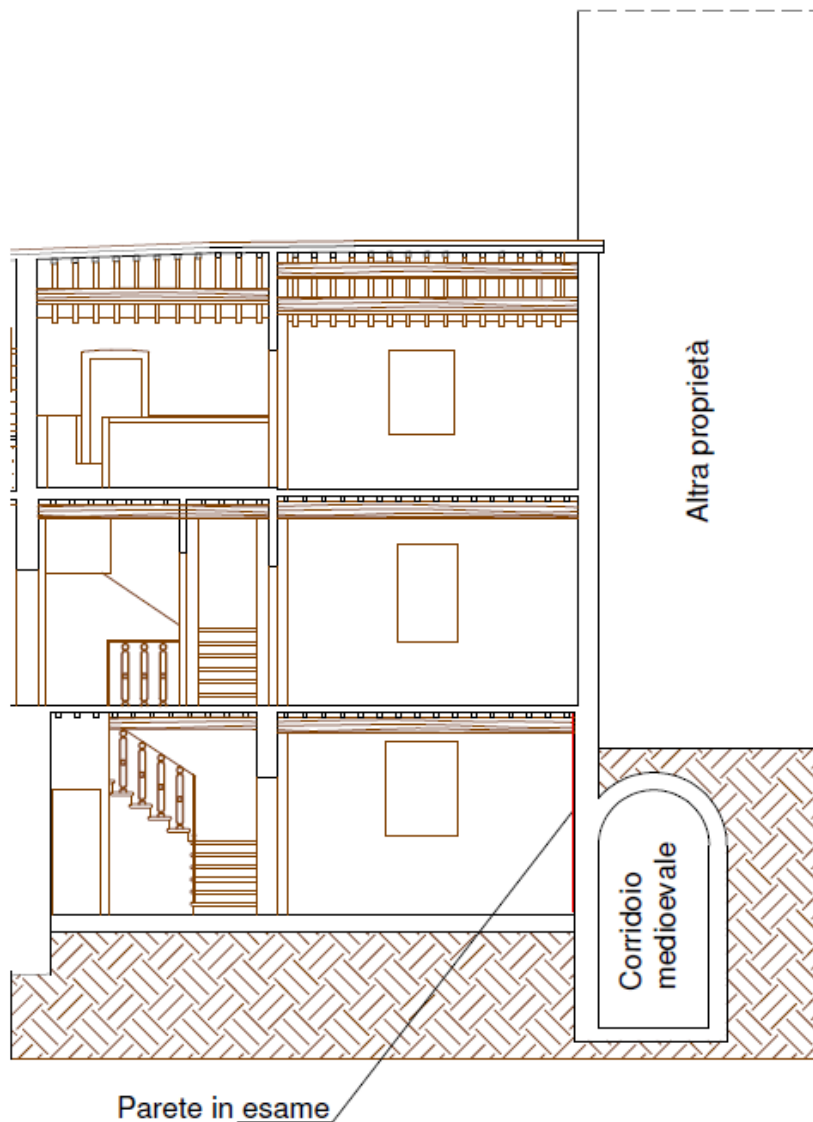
Sezione parziale dell'edificio oggetto di intervento
